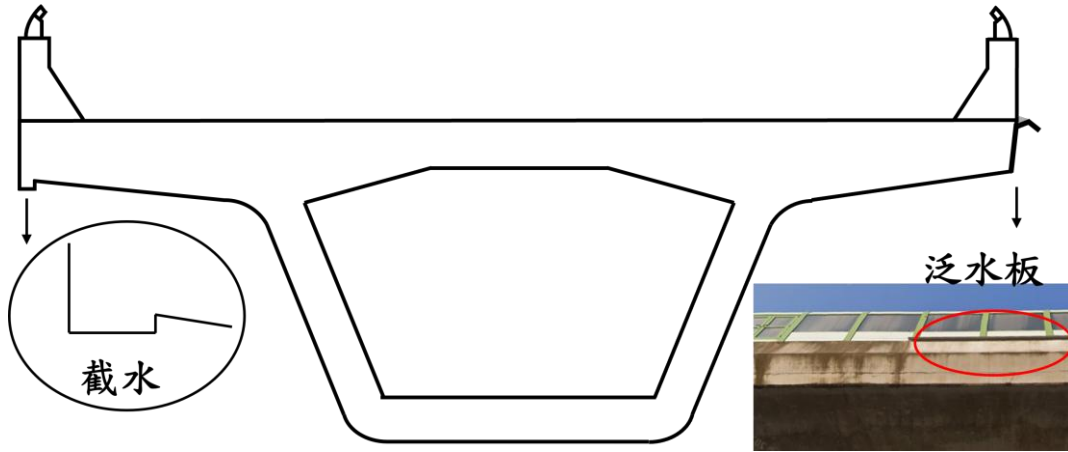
混凝土橋上部結構排水設施示意圖^[17]
